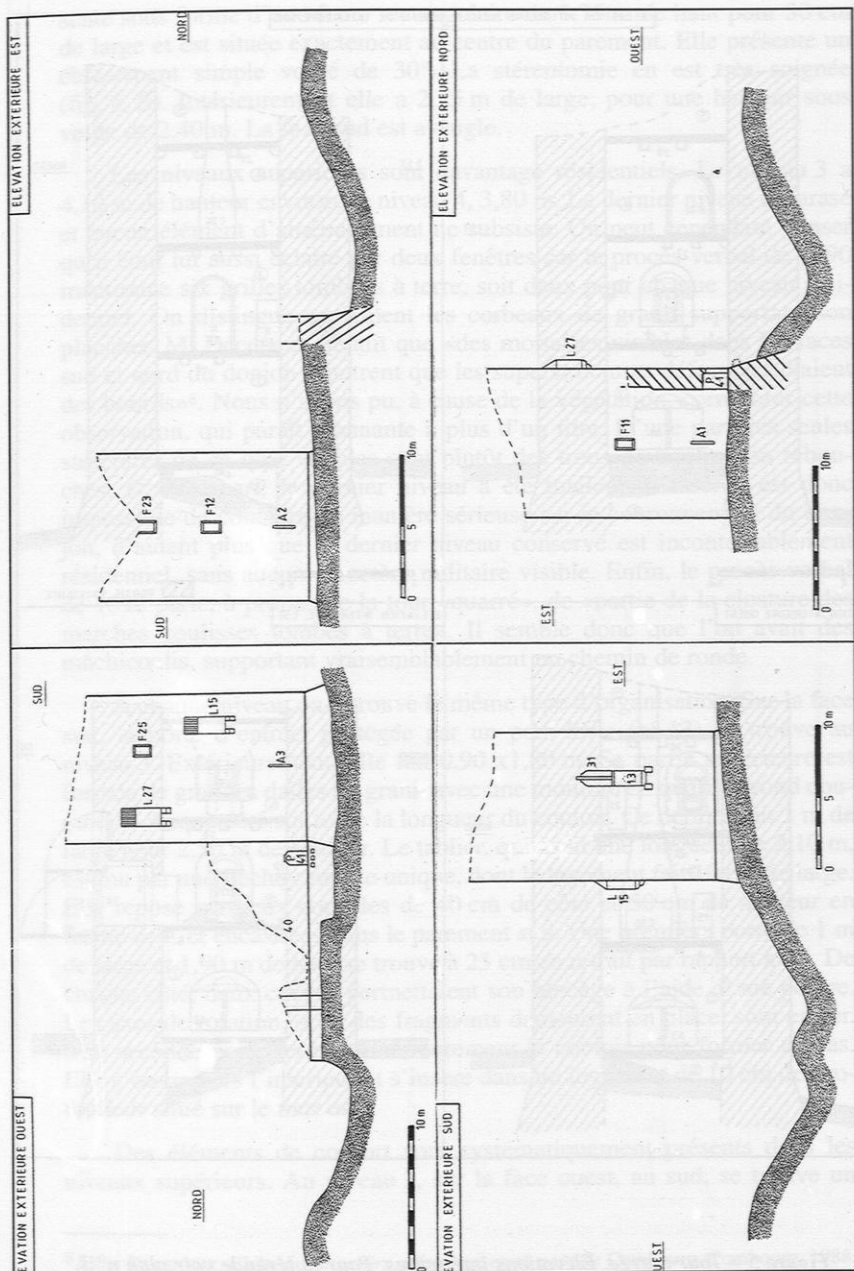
Tour carrée. Élévations extérieures. Pour la légende voir plan n° 3.
